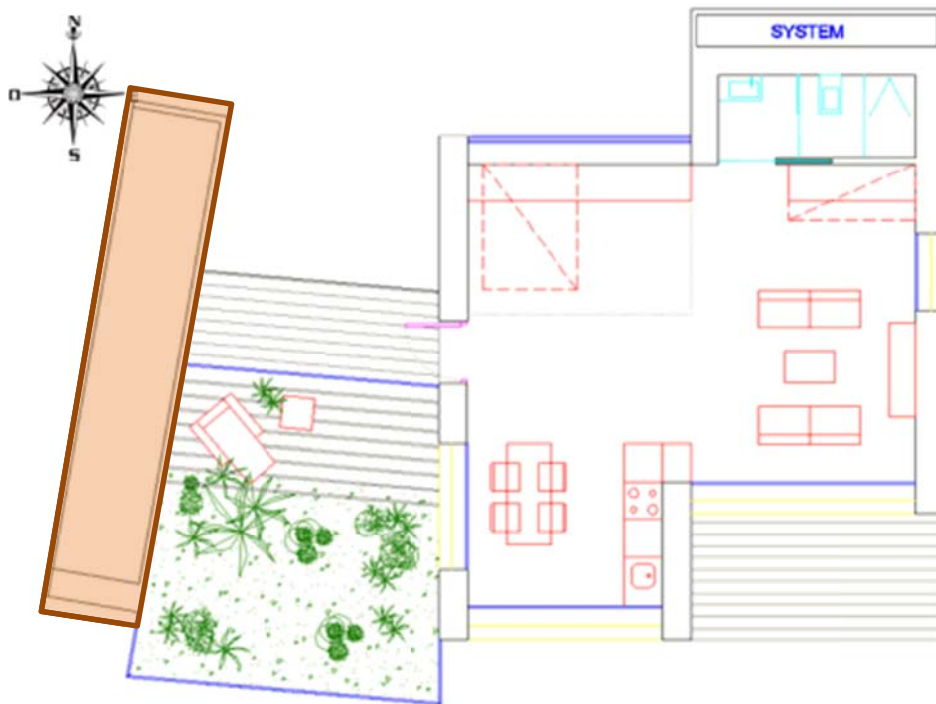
Plano planta segunda propuesta VIA-UJI. Fuente: Equipo VIA-UJI.
